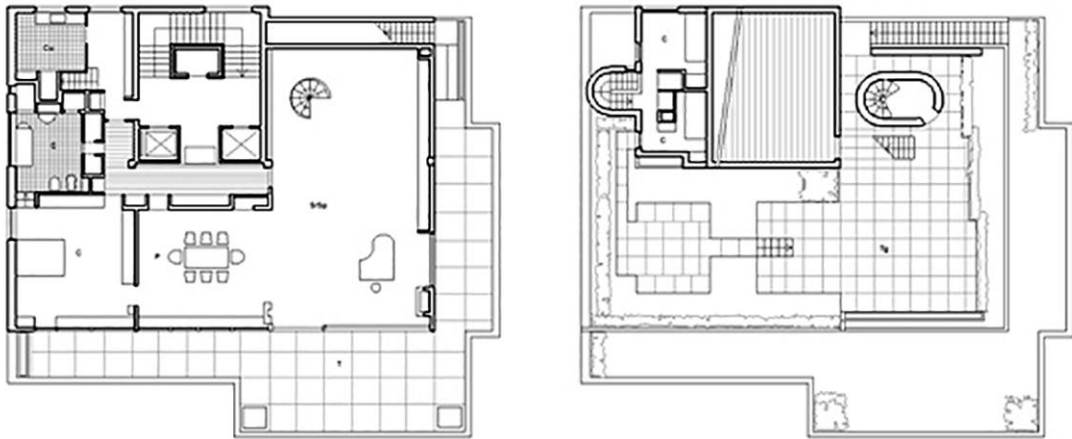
Penthouse Charles de Beistegui, Grundriss Erdgeschoß und Grundriss Obergeschoß
